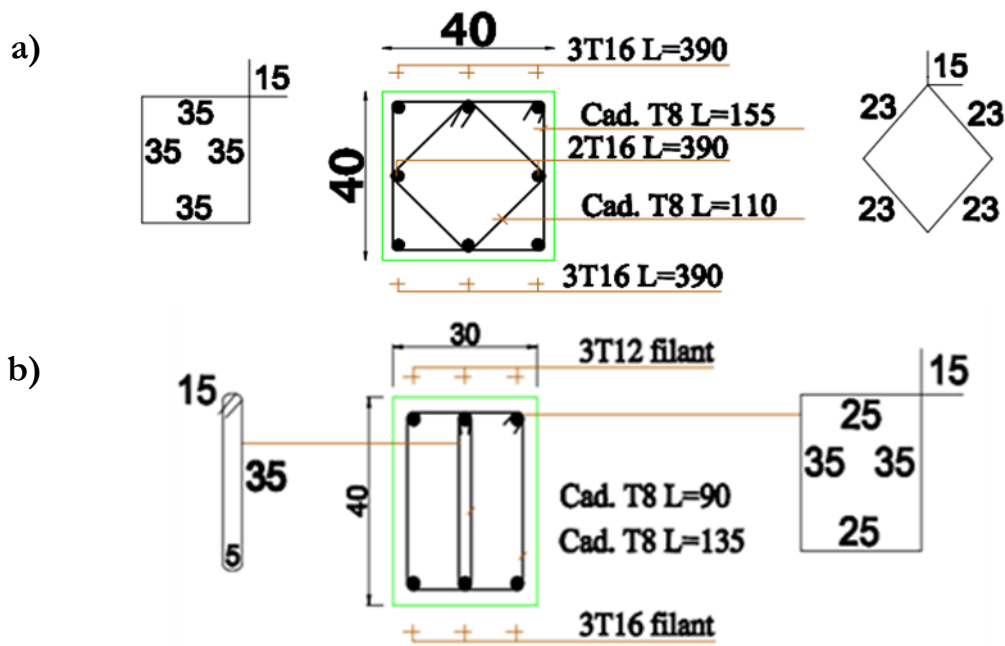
Sections et ferraillage : a) poteaux - b) poutres
